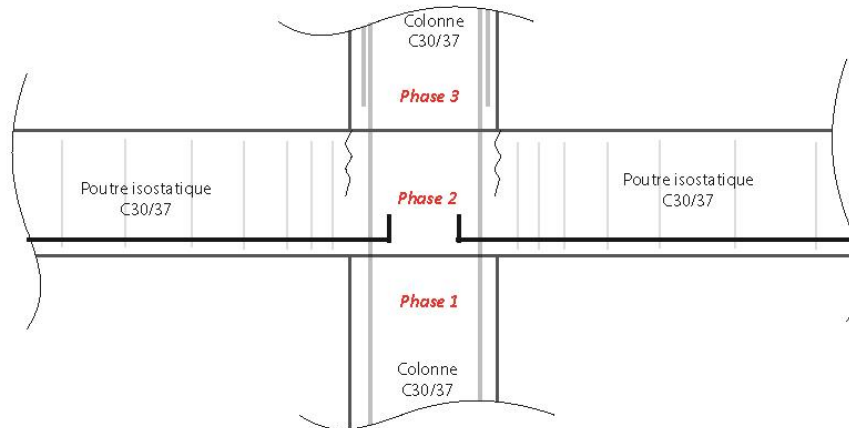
Schéma de principe fonctionnement poutre – colonne
